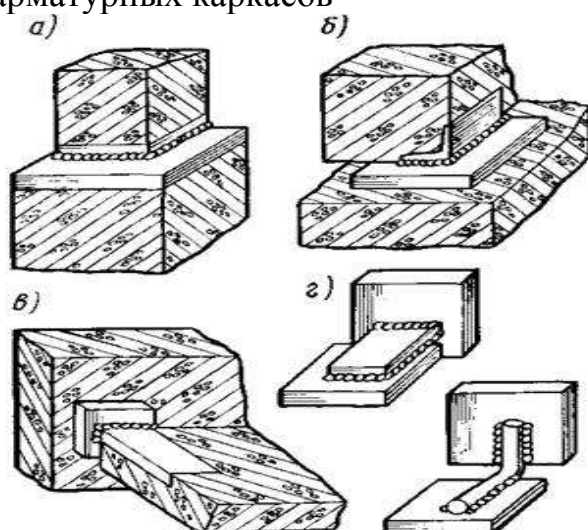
Монтажные соединения сборных железобетонных элементов
